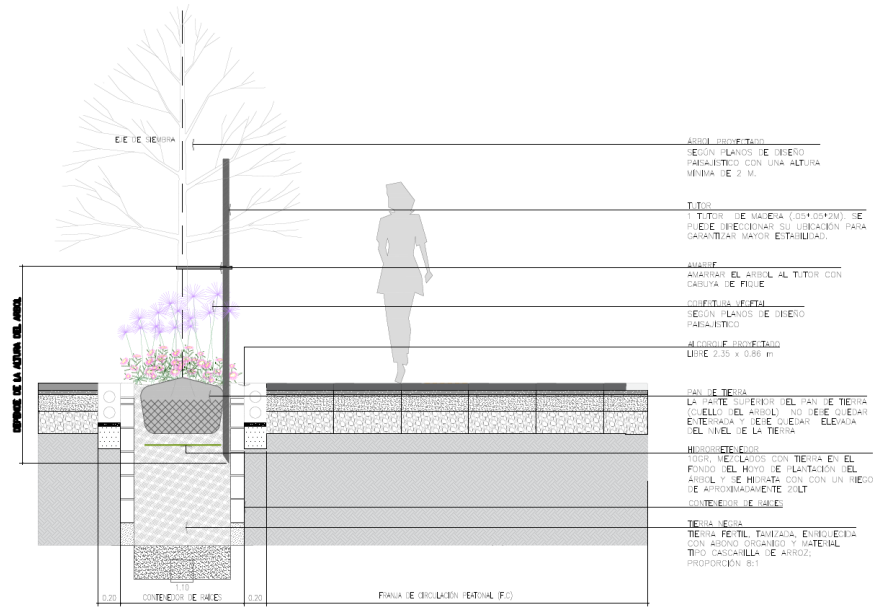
Detalle sección plantación en contenedor de raíces de 0.86 x 2.35 metros.
